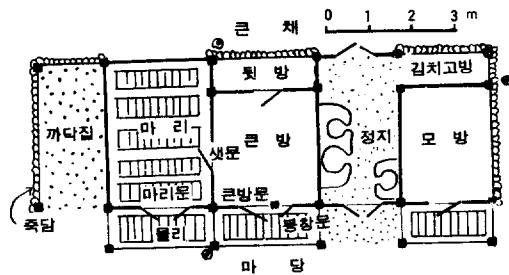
清溪里 池洞烈氏宅 큰채 平面図
